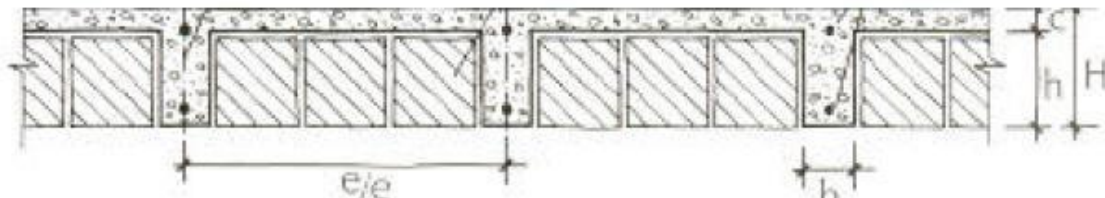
COUPE TRANSVERSALE D'UN PLANCHER
